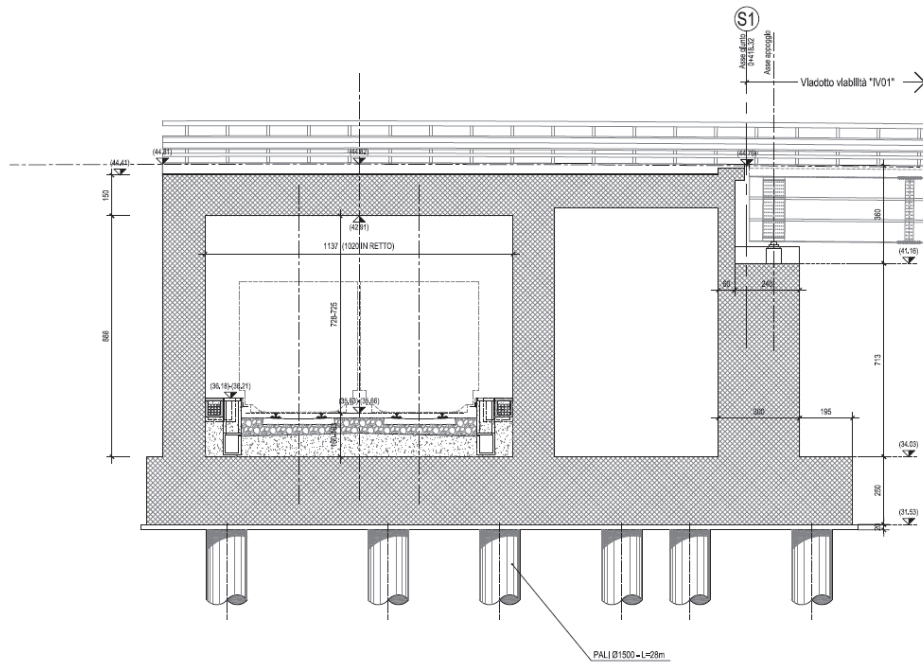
Sezione trasversale in asse spalla cavalcavia
